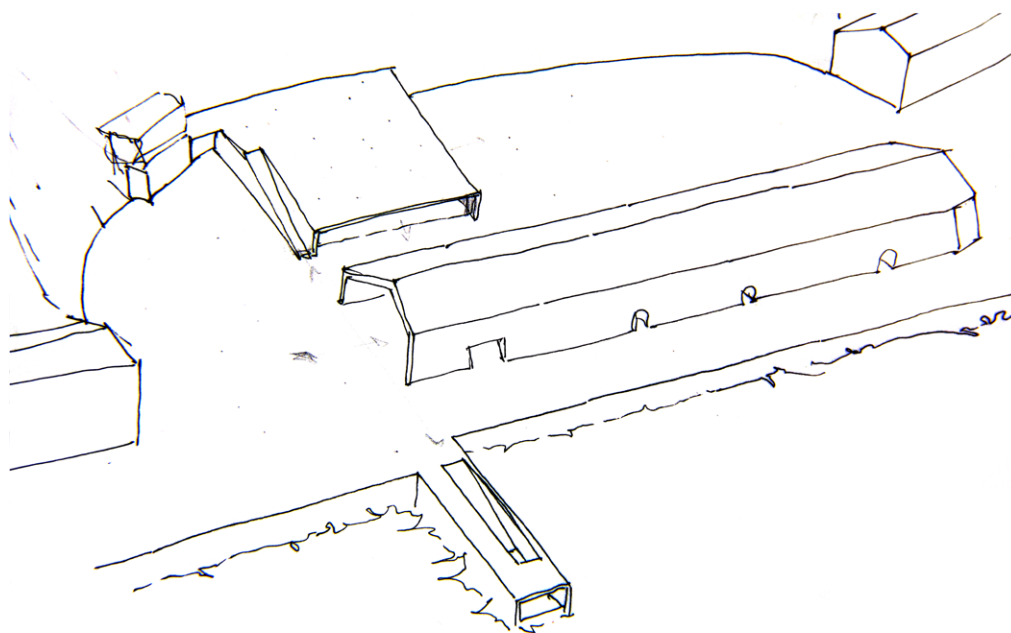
Corte do pontão e da relação entre o plano terrestre e o plano de água
